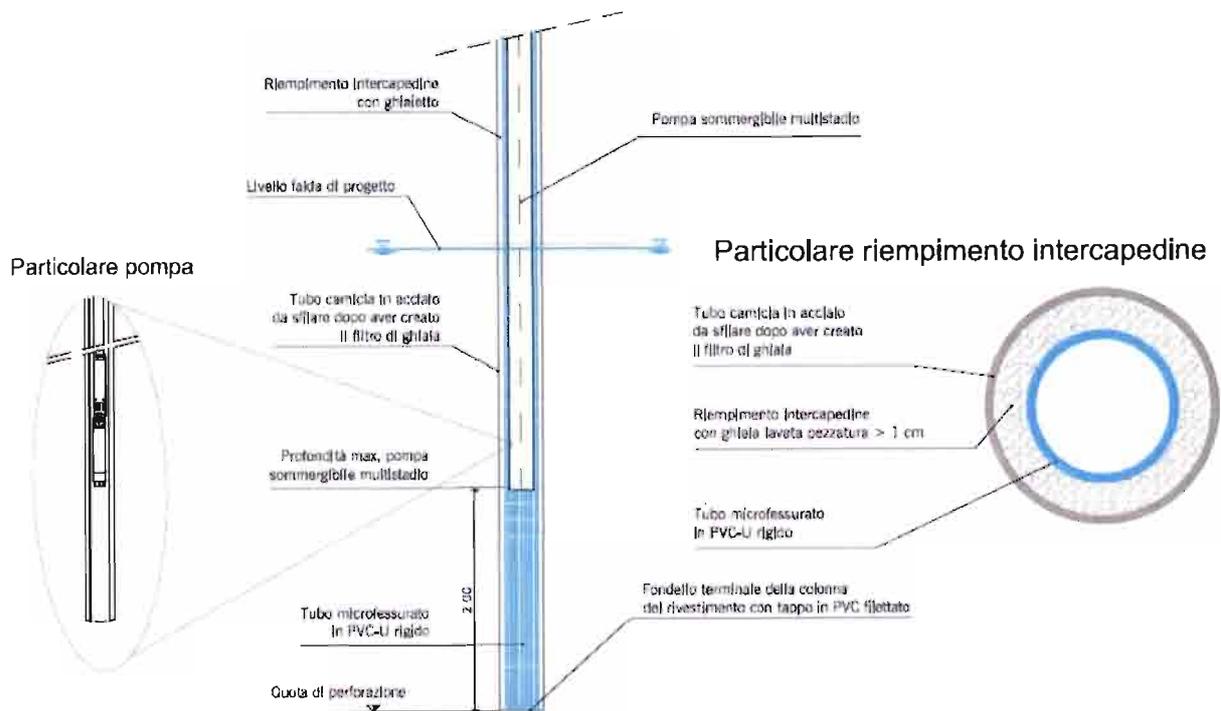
Sezione tipo del pozzo e particolare riempimento intercapedine.
